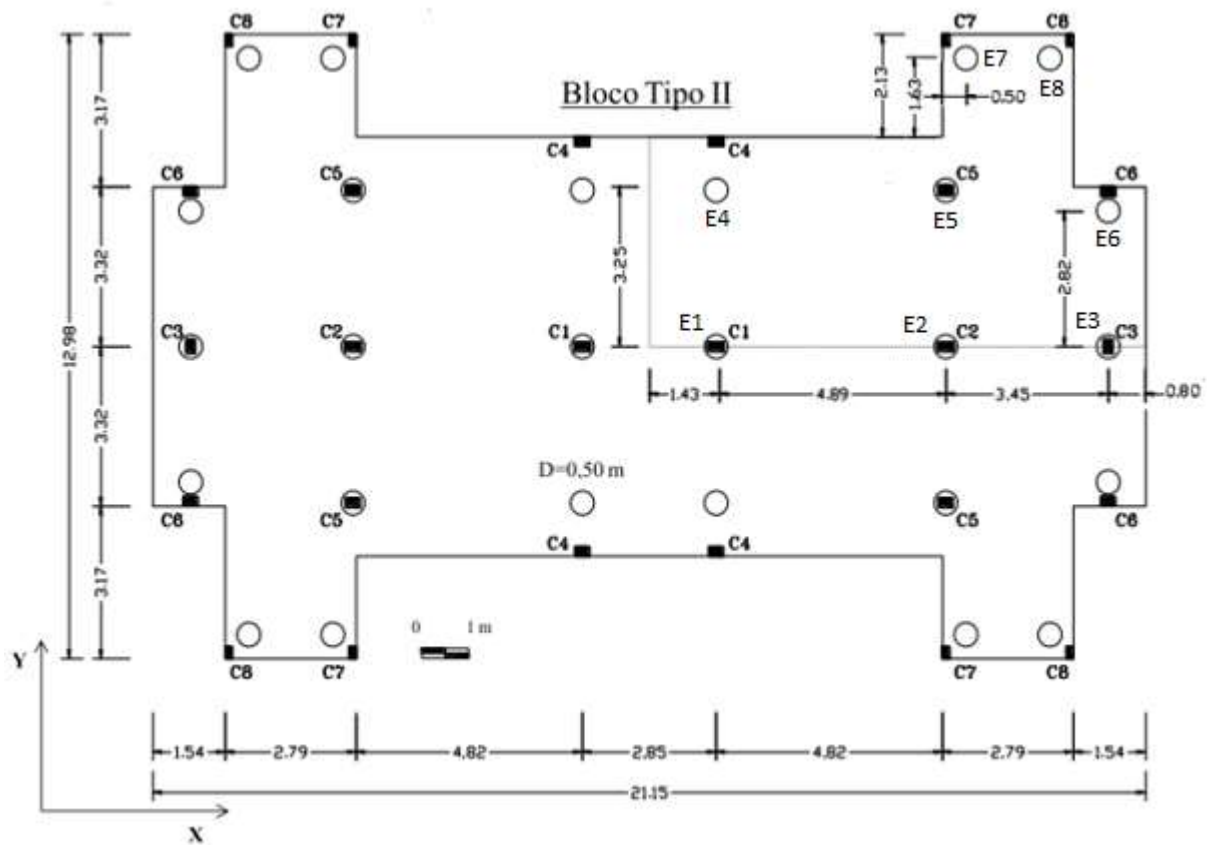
Vista em planta baixa do radier com 26 estacas para o bloco tipo II (Castillo, 2013).
